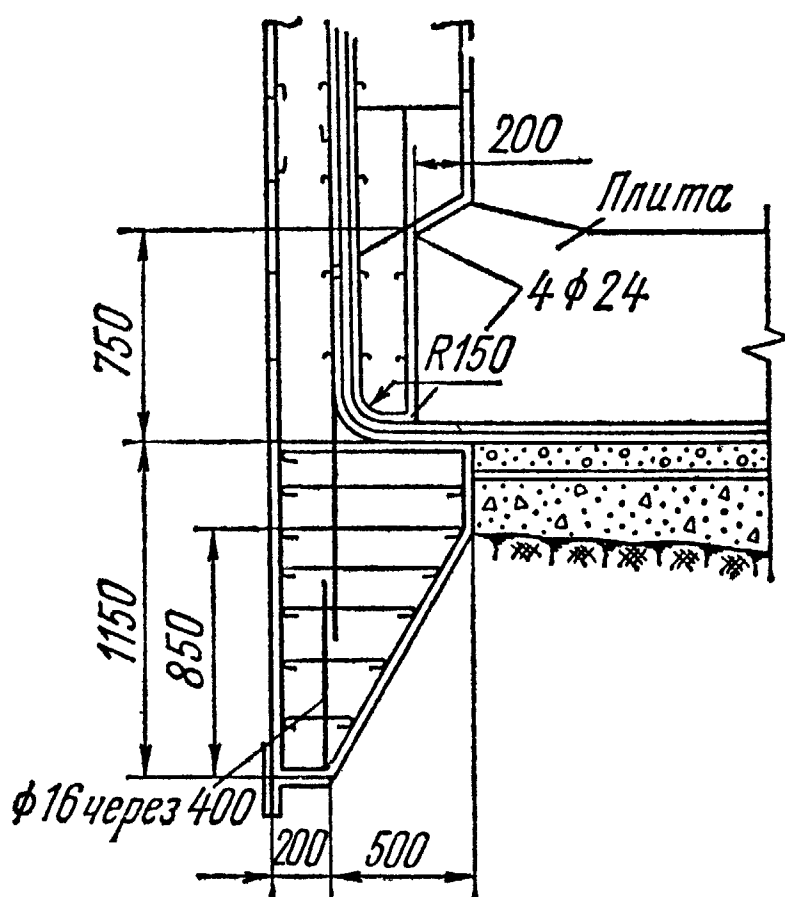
Конструкция железобетонного ножа опускаемого колодца
